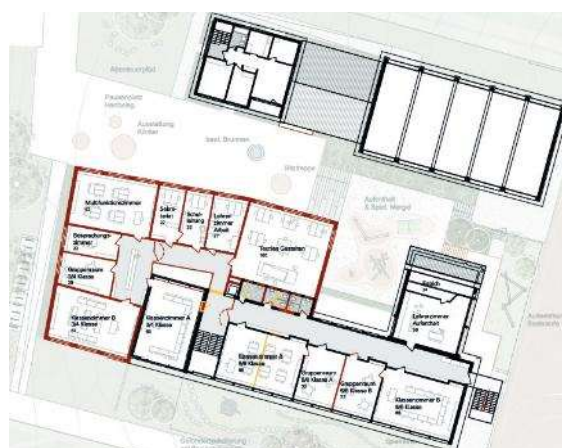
Schlussabgabe, Grundriss Obergeschoss des Team 38 Architekten AG mit Weber Brönni-mann Landschaftsarchitekten AG
